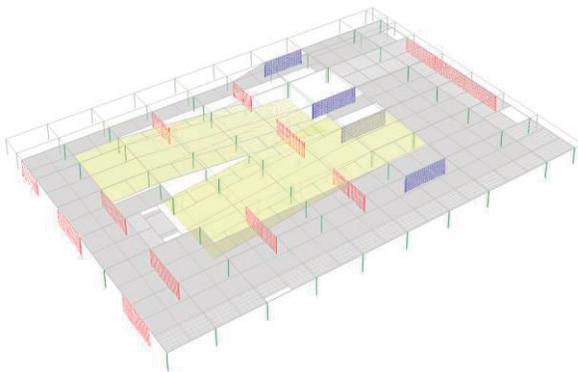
Estructuración de Podio: en color amarillo se muestran las rampas entre niveles S2 a S3
